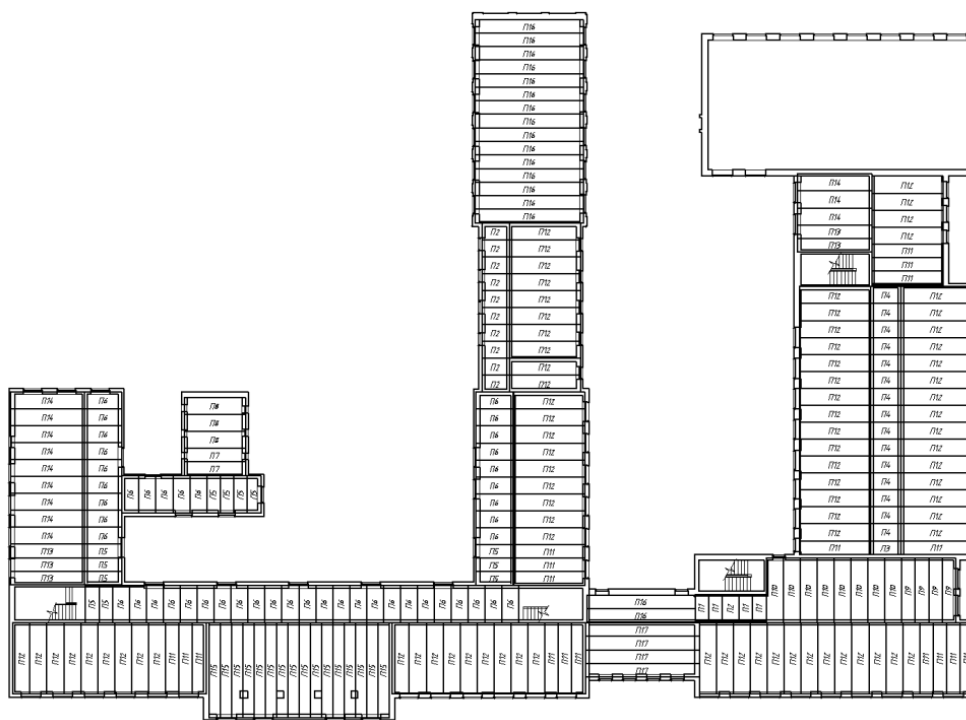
Схема розташування плит перекриття 1-го поверху
